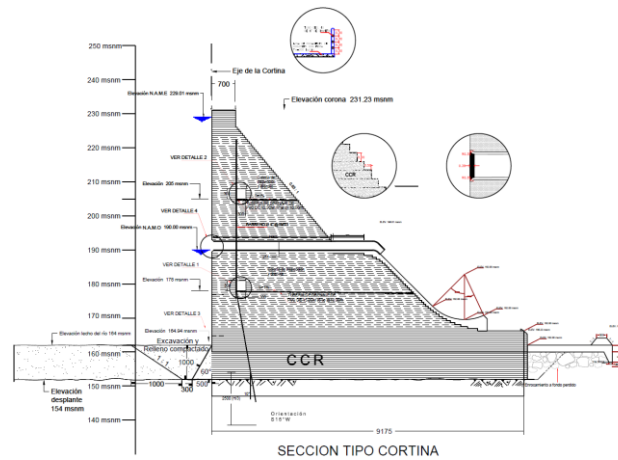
Sección Tipo Cortina con la primera propuesta de modificación
